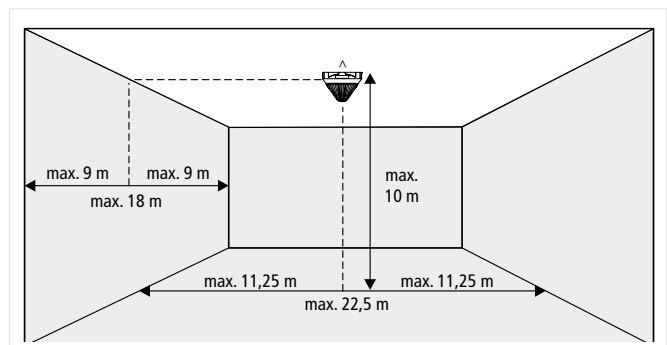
Projektierung Pyra X-M-10 Decke mit Lichtfarbe weiß
